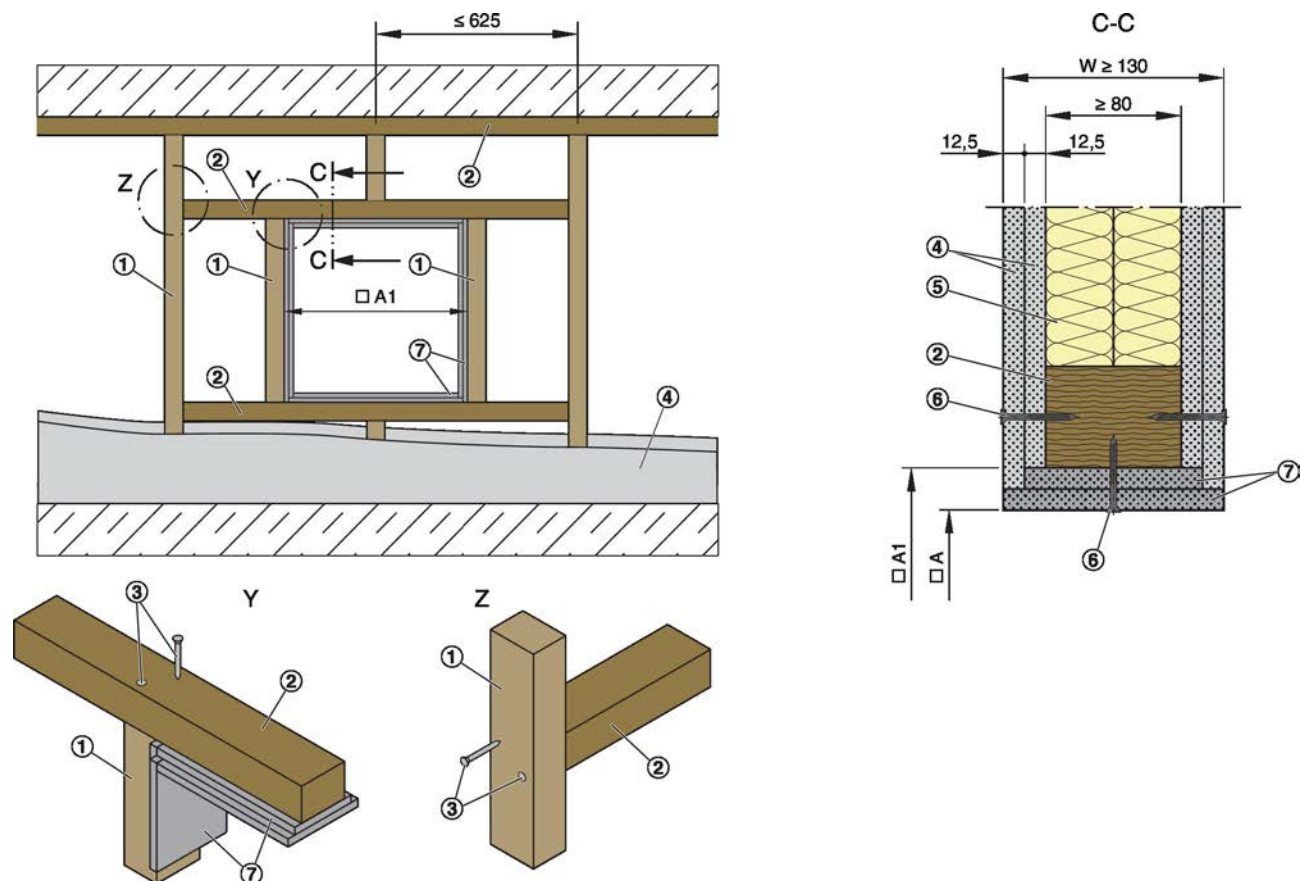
Pared ligera de sectorización con entramado de madera y aislamiento en un lado
